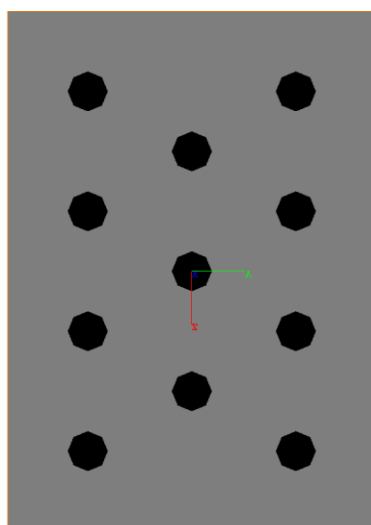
Vista planimetrica del modello GROUPv2016.
